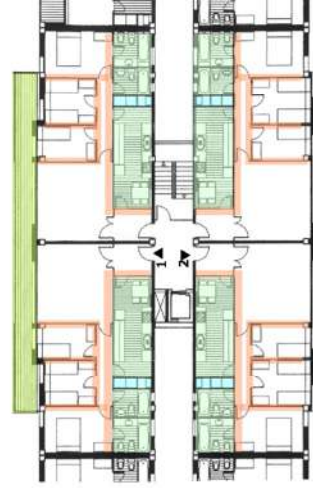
Fragmento Planta Pavimento Tipo E: 1/300
